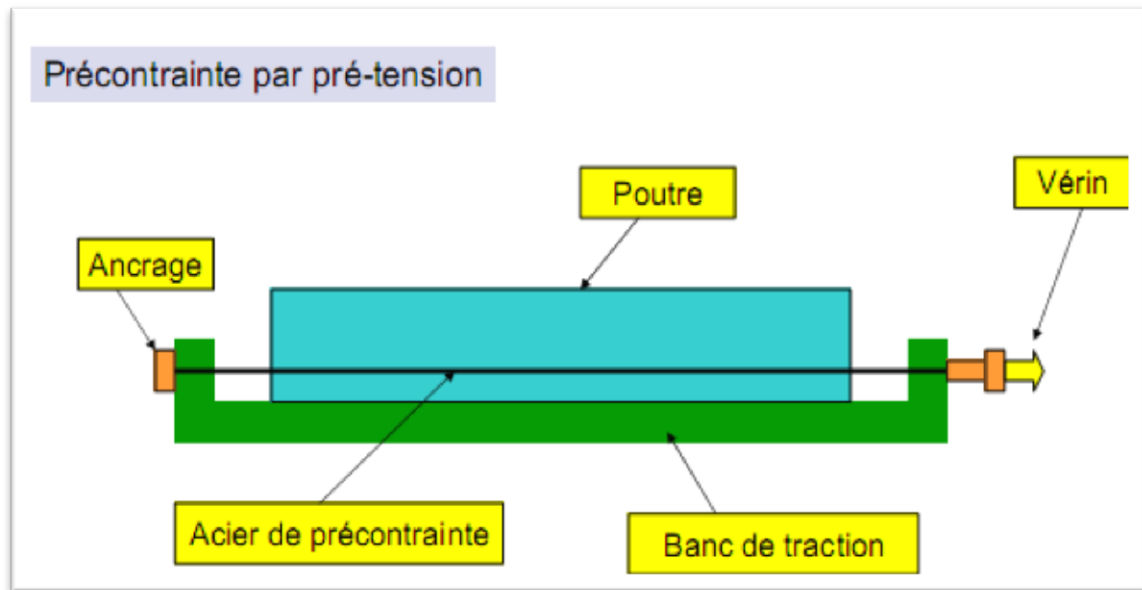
Coupe longitudinale d'une poutre en béton précontraint pré tension
